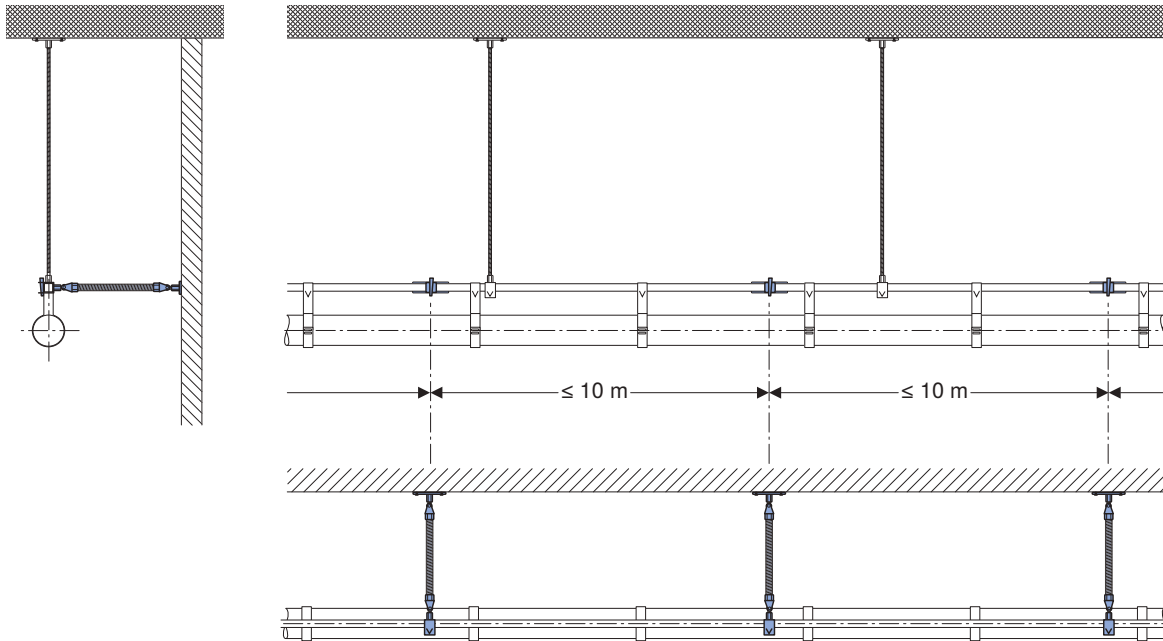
Disposition des kits de fixation de renfort Geberit Pluvia latéralement sur le mur
